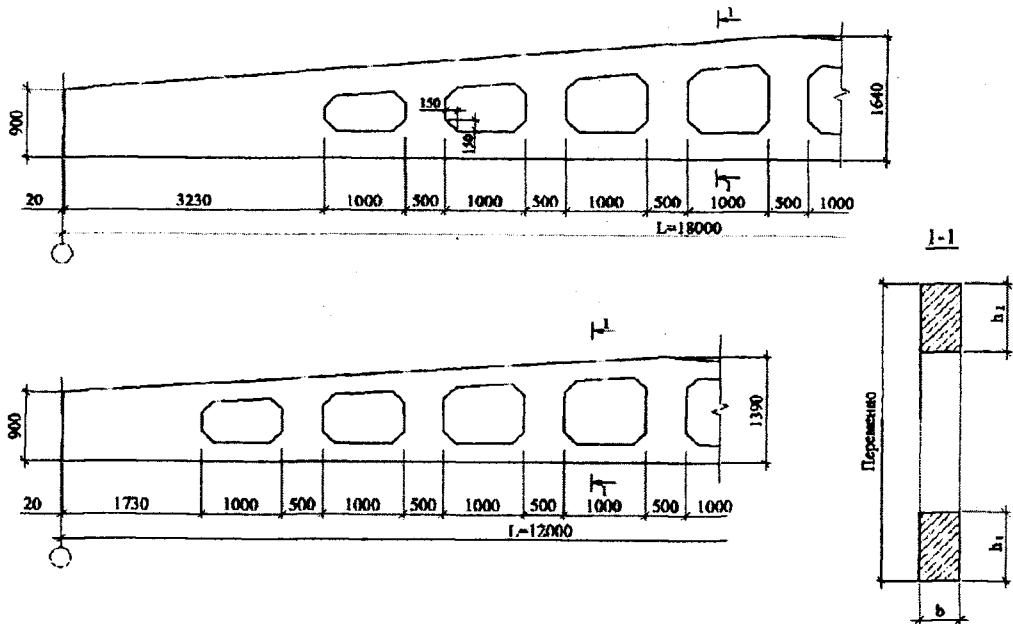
Балки скатных покрытий пролетом 12 и 18 м
